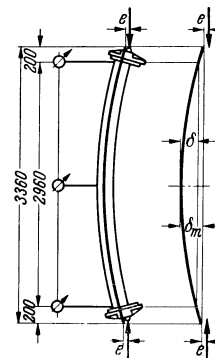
Ausbiegung einer außermittig gedrückten Stütze.
